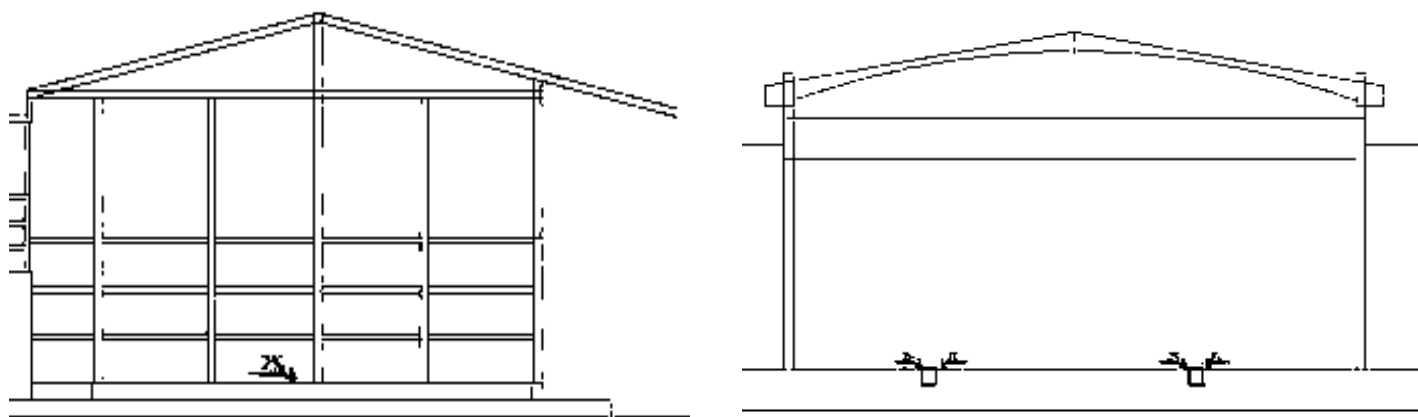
se observa la estructura de nave para el área de sacrificio compuesta de una estructura prefabricada.
